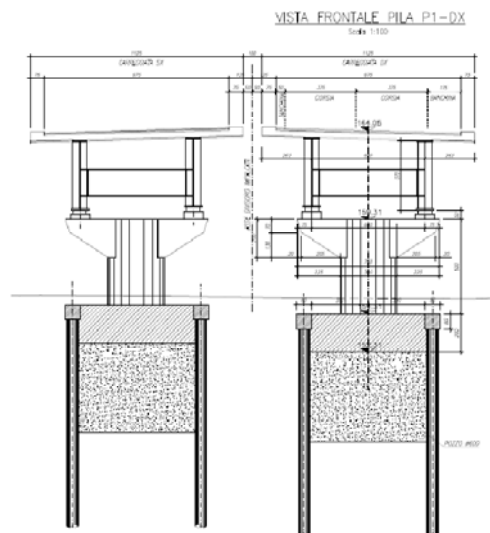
Sezione trasversale pile Viadotto sul fiume Ornate
